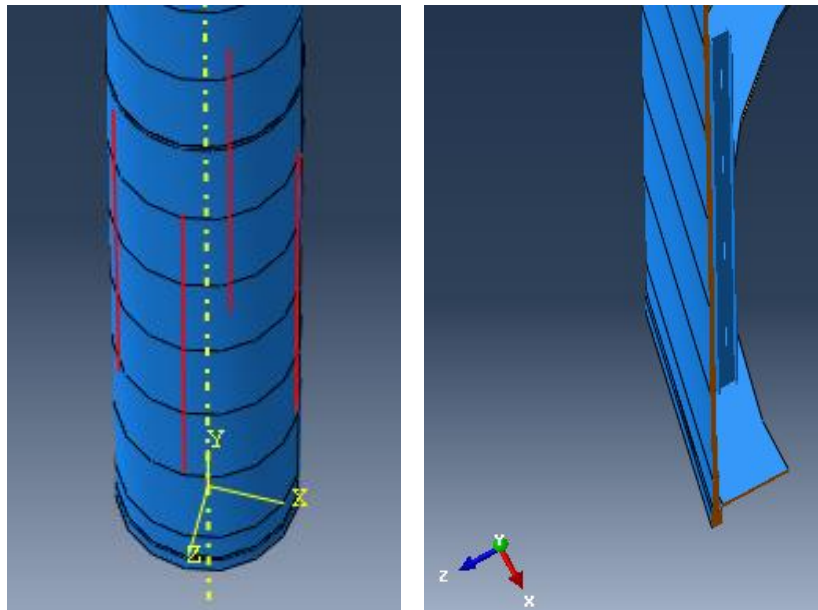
4 vigas IP80 ensambladas y unidas a torre
